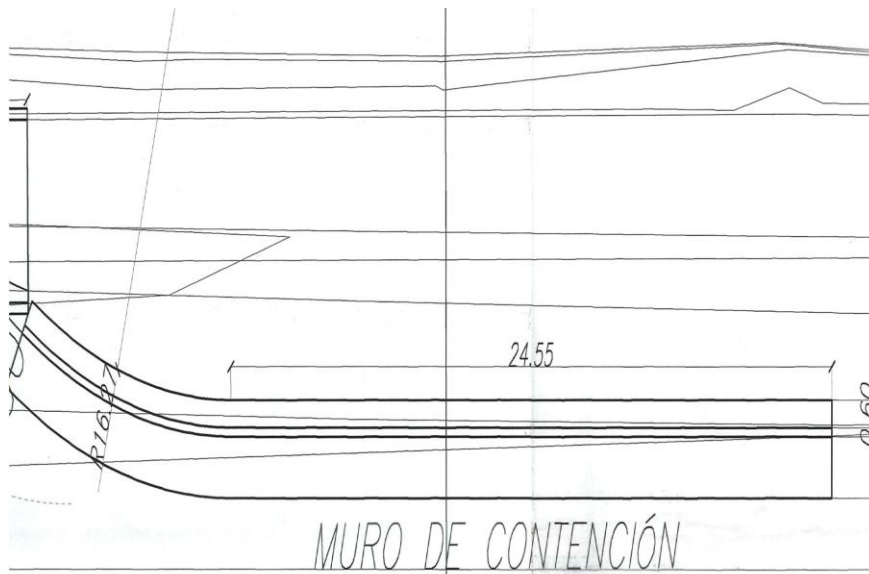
Planta muro de contención canal aguas lluvias vía doble calzada.
